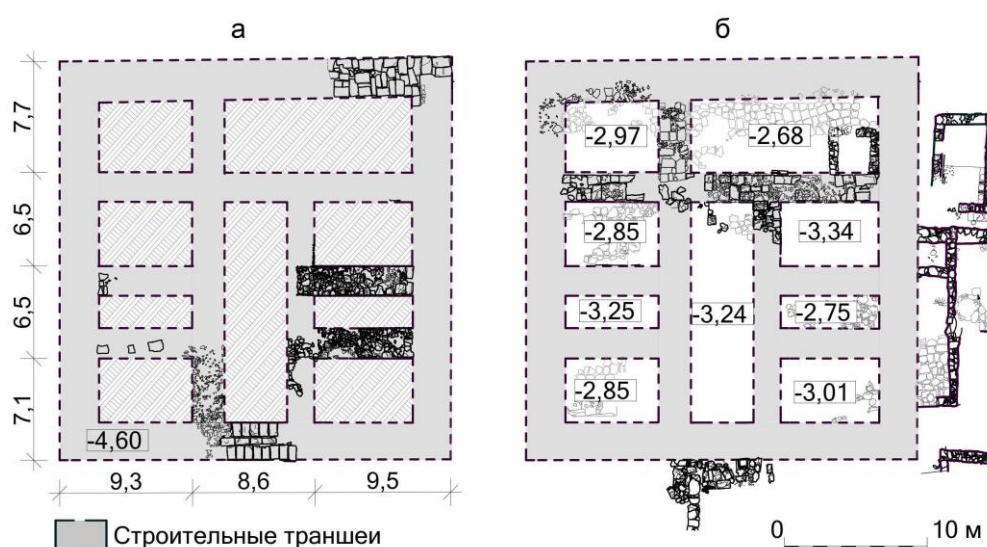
План строительных остатков цитадели: а) план строительных остатков фундаментов; б) план строительных остатков 1 этажа
